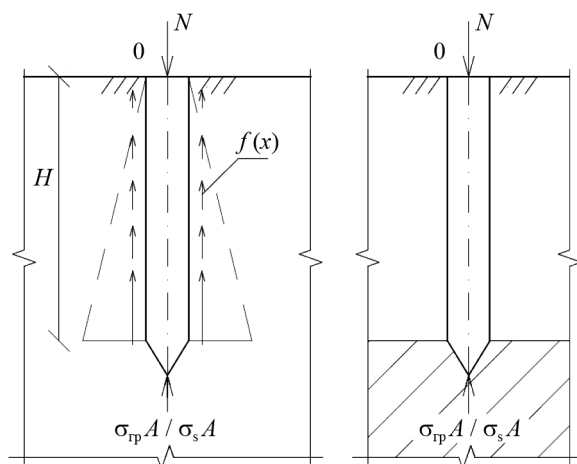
Расчетные схемы работы свай и свай-стойки в грунте основания по СП 24.13330.2011
